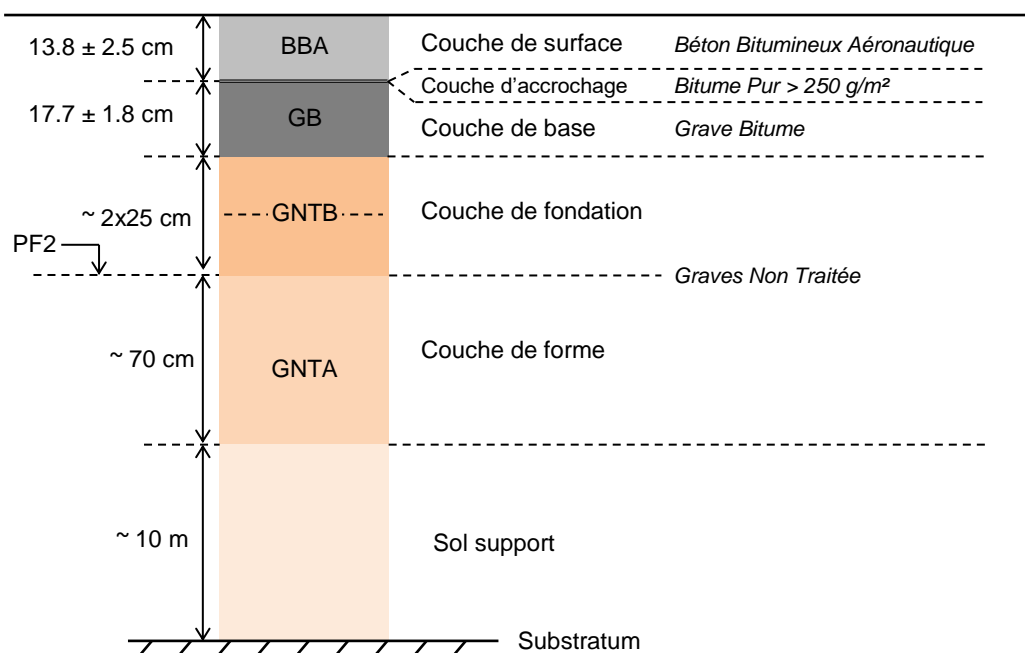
Structure de chaussée de la planche d'essais au niveau du point de mesure HWD
